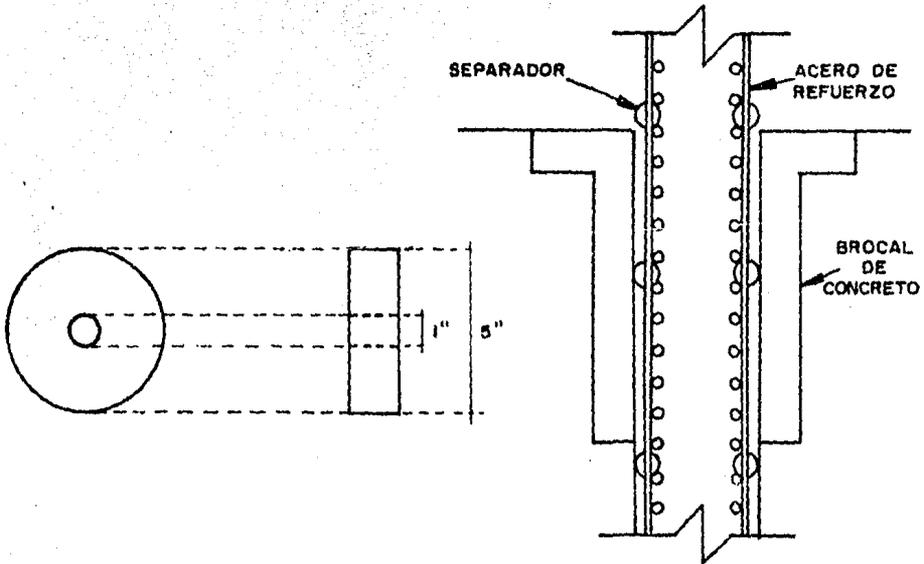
SEPARADORES DE CONCRETO PARA DAR CUBRIMIENTO AL ACERO DE REFUERZO.
